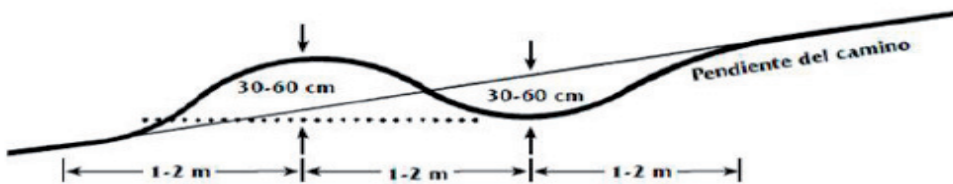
Sección transversal de un caballón desviador. Imagen: USDA, Forest Service.
